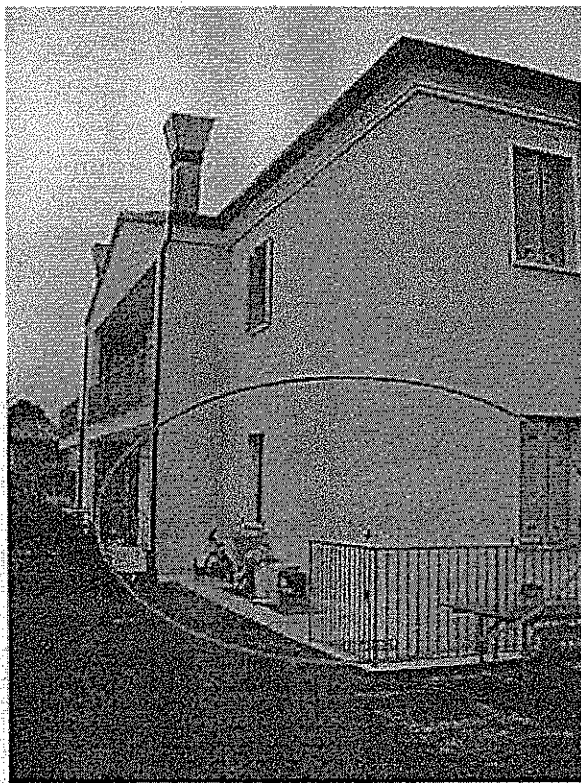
Come foto N° 1 con vista da sud-est.
